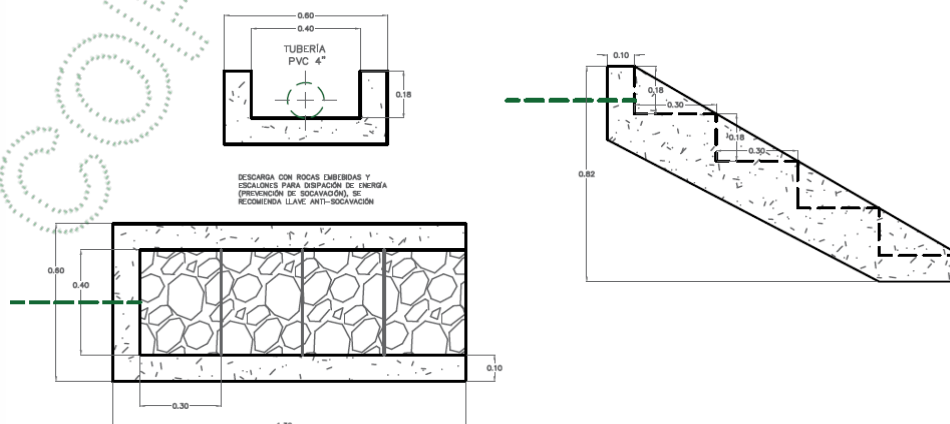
Detalles de estructura de descarga Condominio San José Campestre
